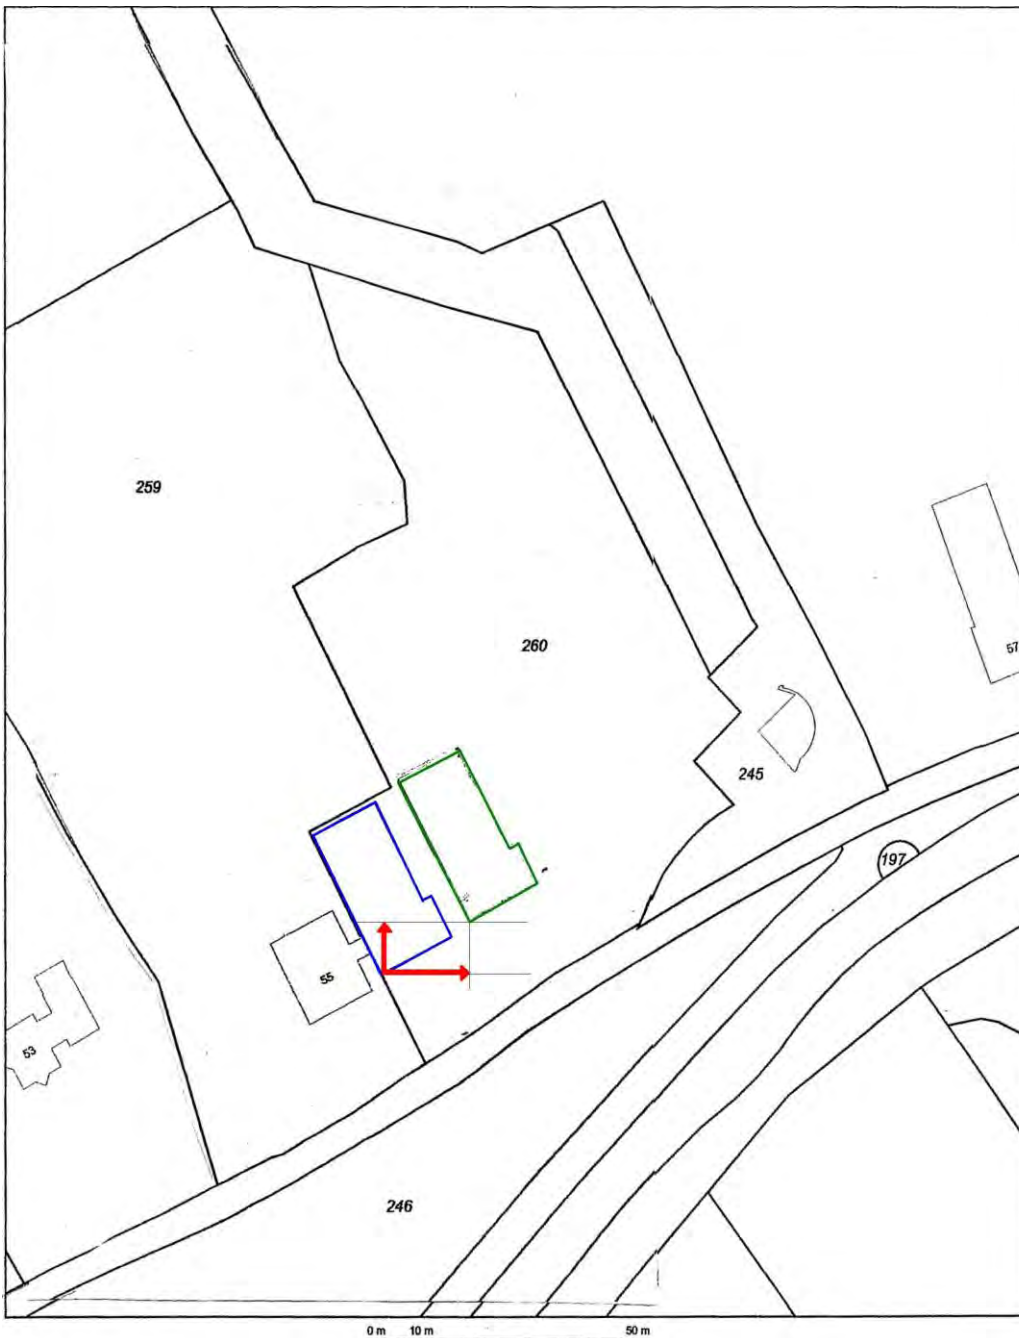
Het plangebied, met rood aangegeven. De te verplaatsen voormalige boerderij met geel
